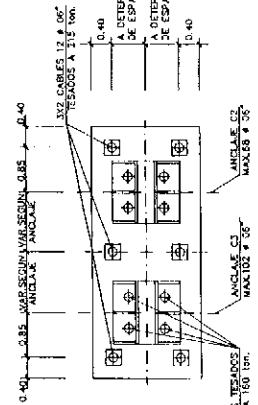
Anclajes al terreno. Cables provisionales C-2 y C-3.
